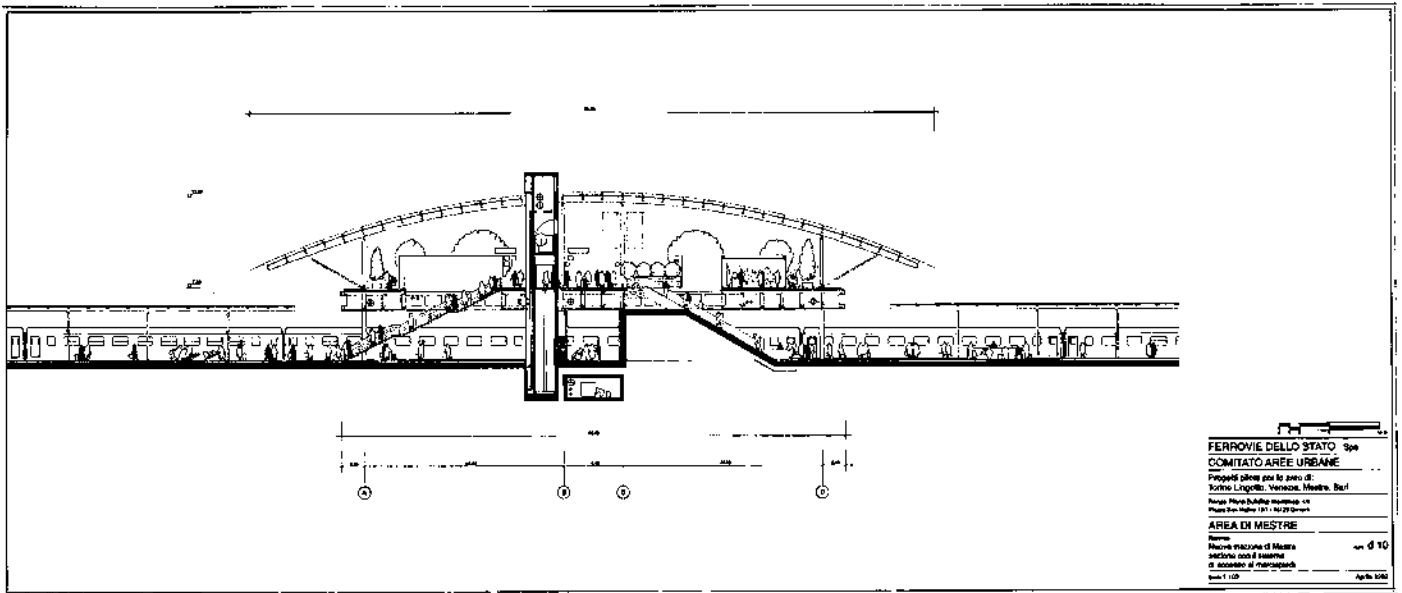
Progetto di stazione a ponte di Mestre: sezione della stazione a ponte tra Via Piave (a destra) e via Ulloa (a sinistra)
